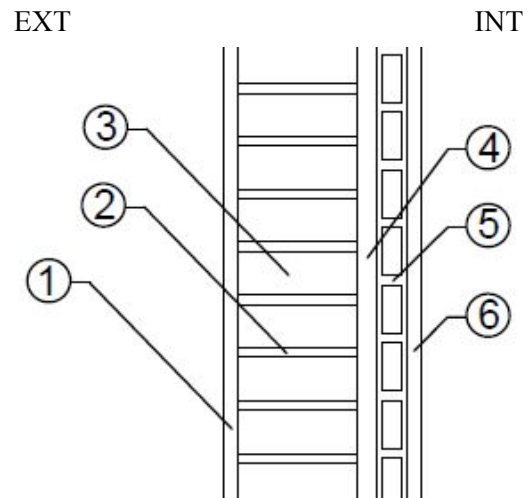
Sección muro tipo 3 (Fuente: Anejo A)
